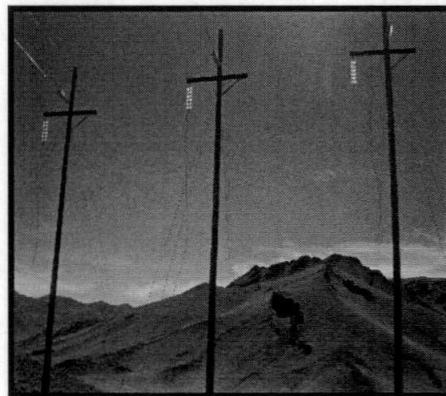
Estructura triposte tipo EE (Estructura N° 194).
